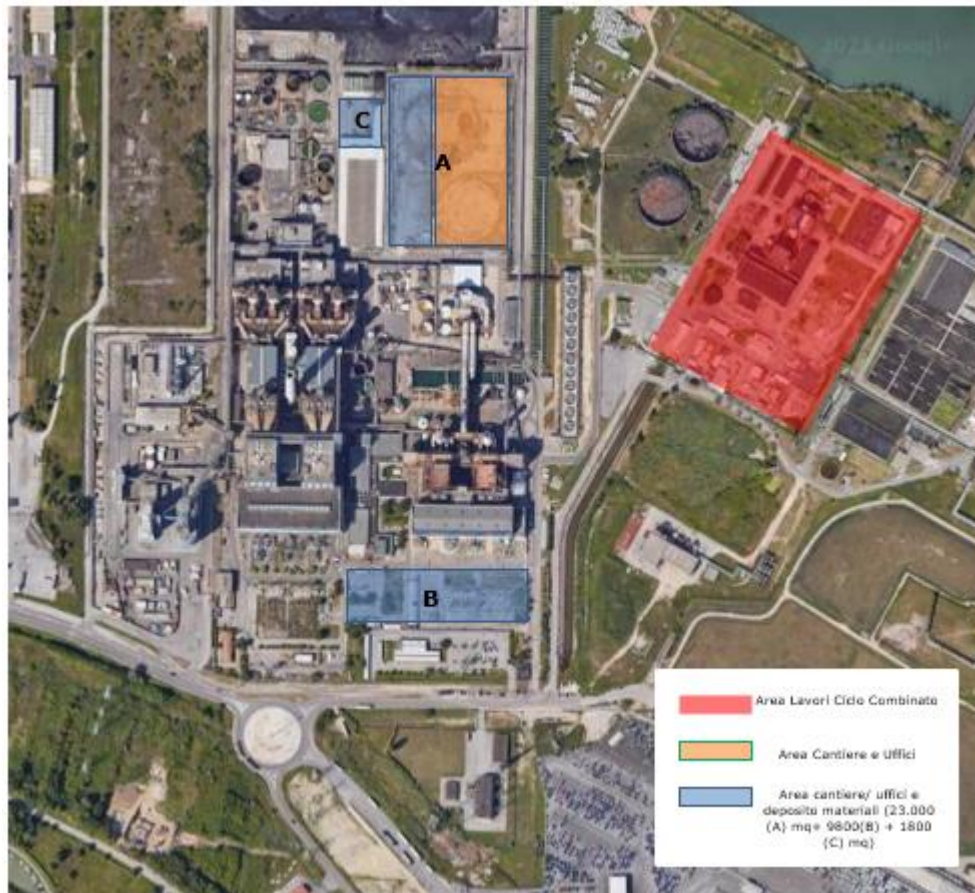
Indicazione delle aree di cantiere previste
